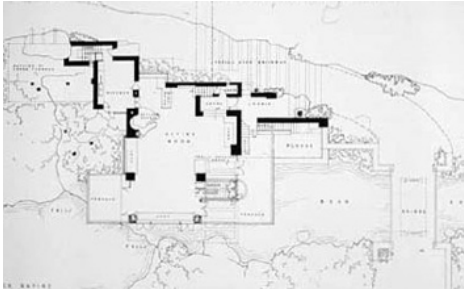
Planta baja, casa E. Kaufmann 1936-1938, Bear Run, Pennsylvania
